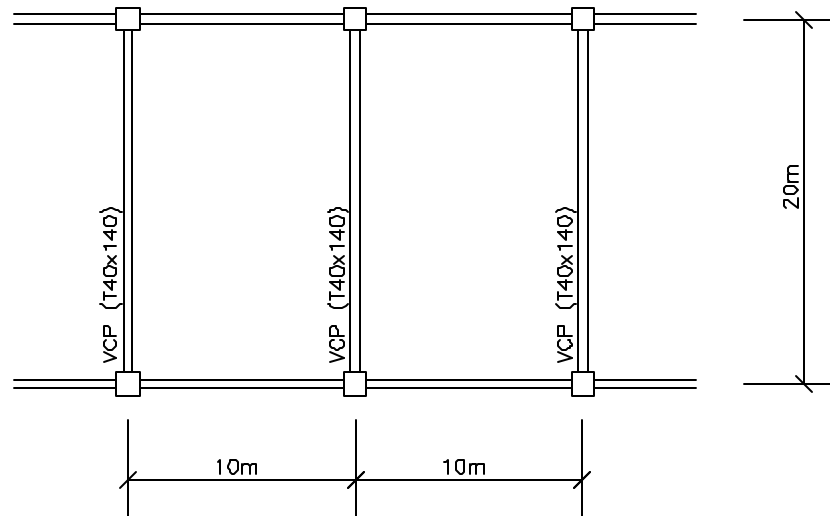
Exemplo 1 - Esquema da planta baixa do pavimento da edificação
